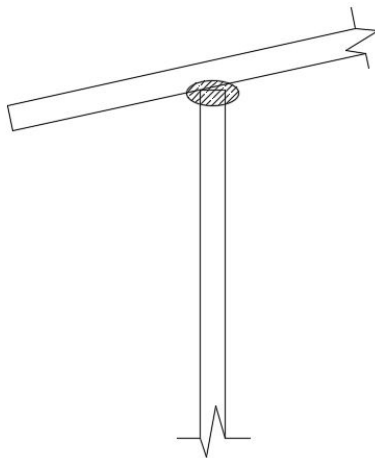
Unión Manto - Techo Soldada. [5]
